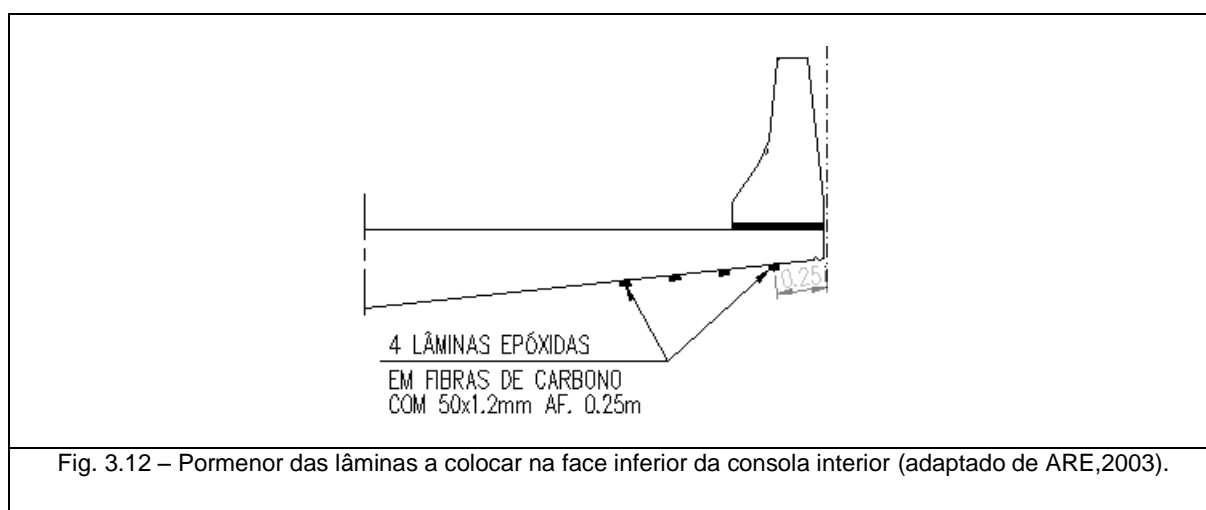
Pormenor das lâminas a colocar na face inferior da consola interior (adaptado de ARE,2003).
